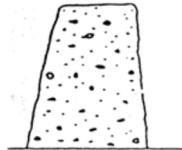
(#) Punjenje i zbijanje betona u kalupu
